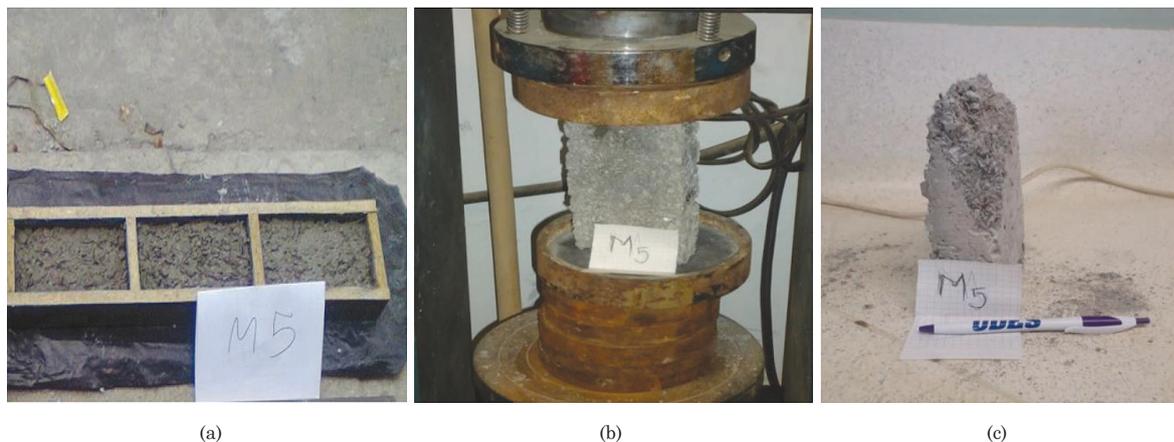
(a) Muestra terminada en el molde, (b) Muestra en la máquina de Compresión, (c) Punto de compresión máxima
